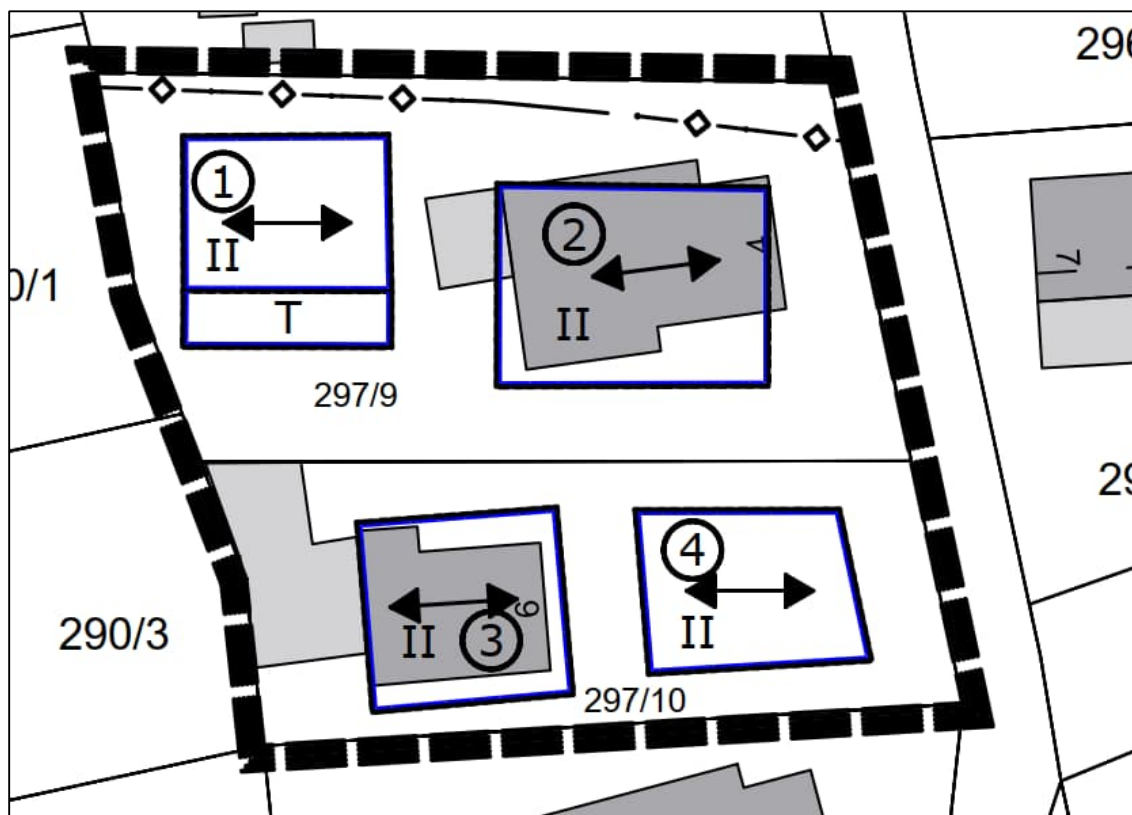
Planzeichnung der 11. Änderung des Bebauungsplans "Lauter Süd" /7/
